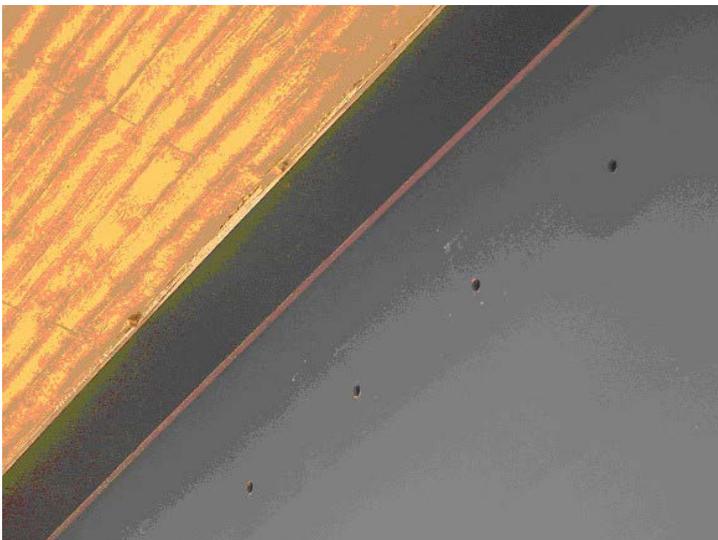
Bild Ausbildung der Schnittstelle Beton
